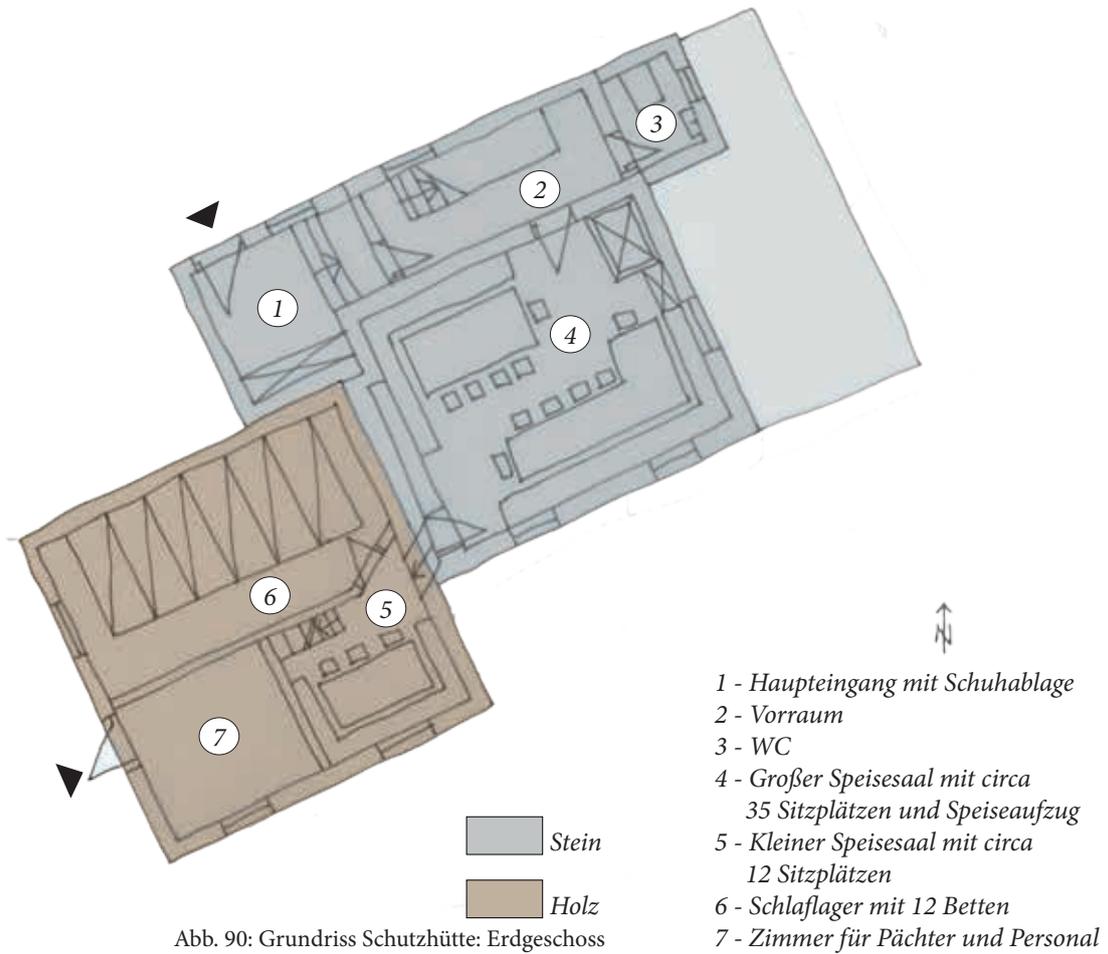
Grundriss Schutzhütte: Erdgeschoss
